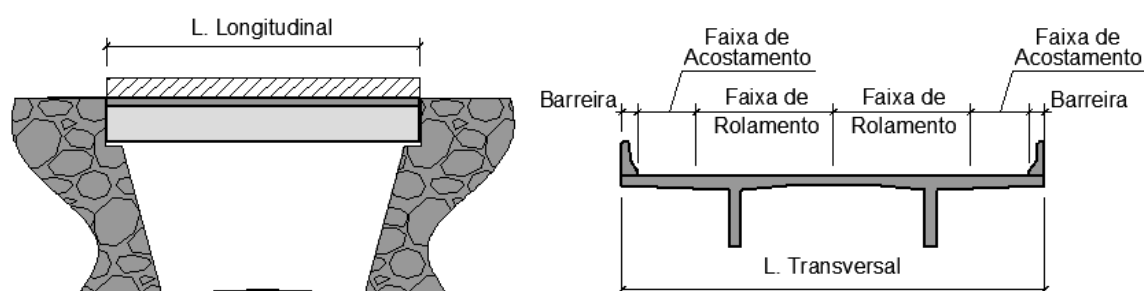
Detalhe esquemático da seção longitudinal e transversal da estrutura (Acervo do autor)
